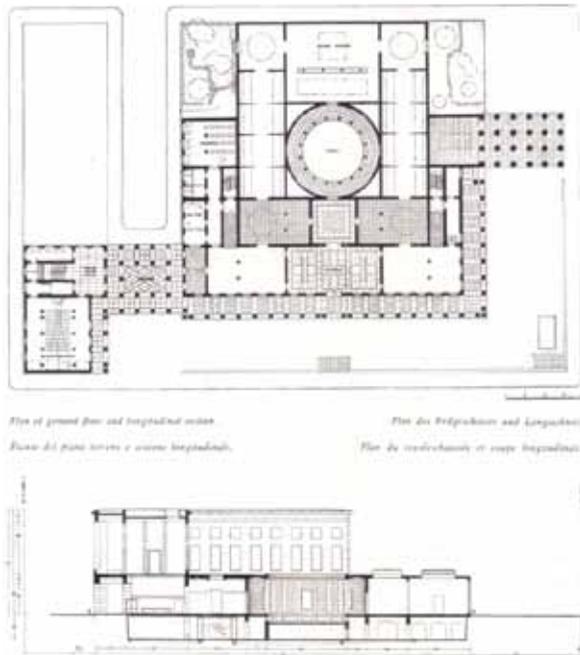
Il Museo di Arte Antica. Pianta del p.t. e sezione (da Architettura).
